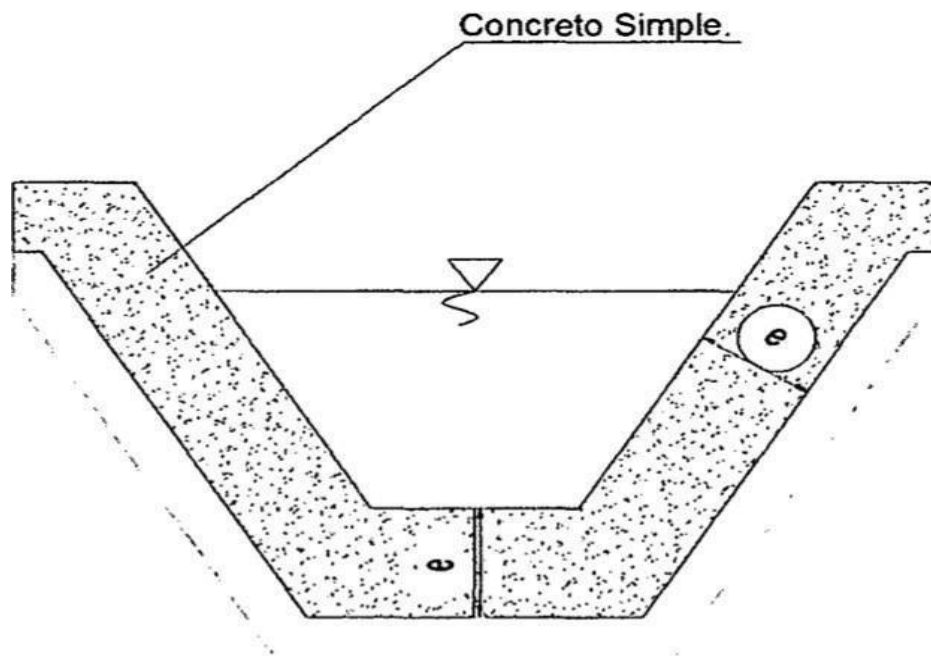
Sección Típica de Un Canal de Sección Trapezoidal Revestido
